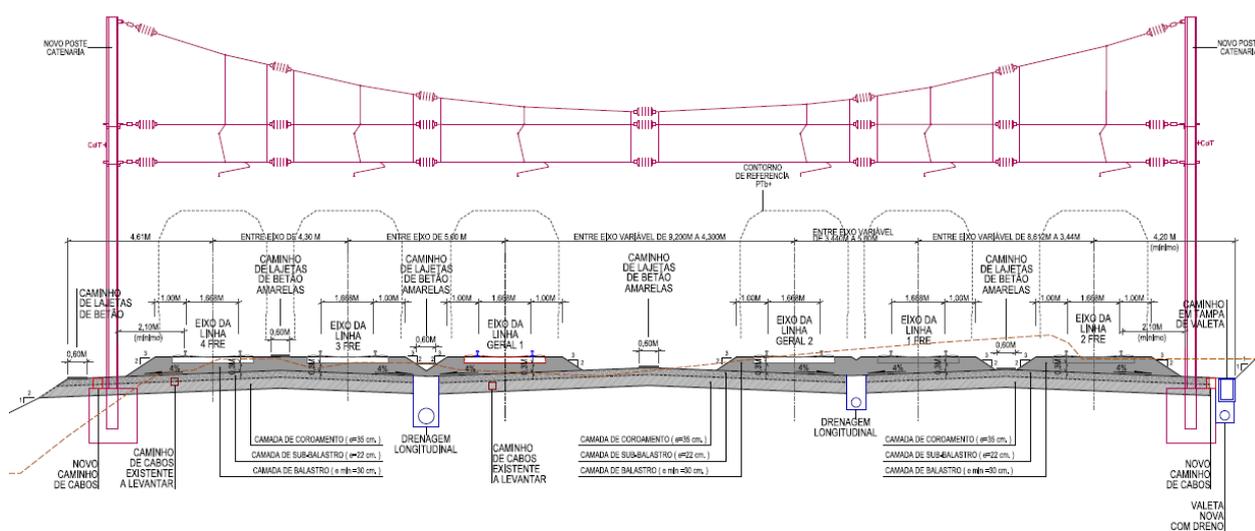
Corte Tipo – Terminal de Leixões – 6 vias
